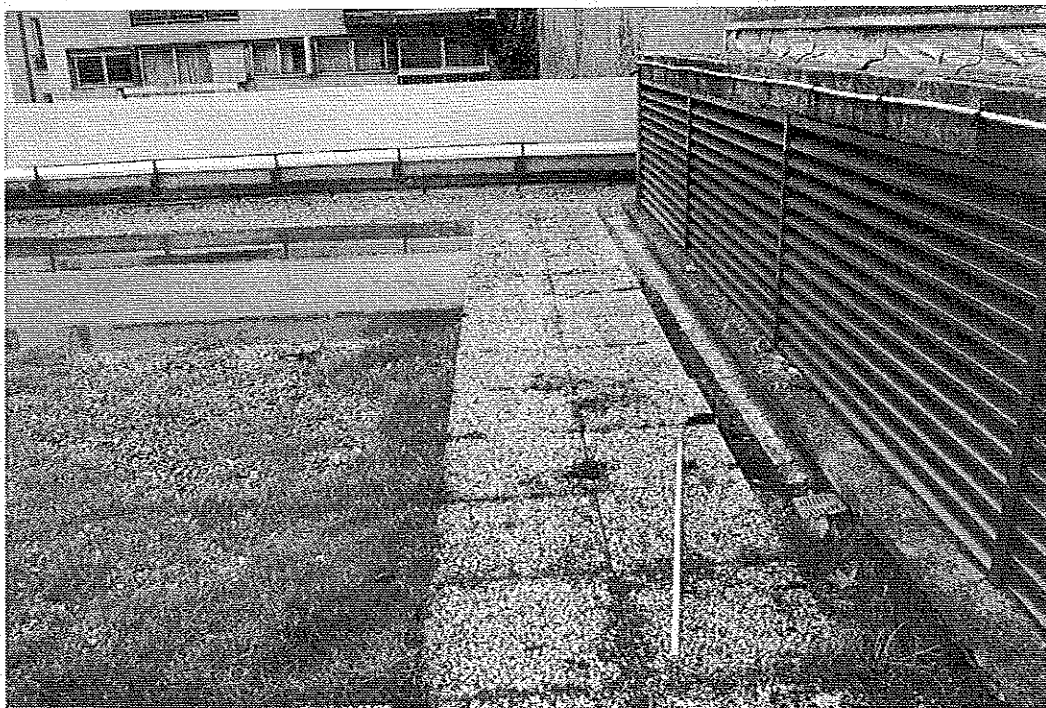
Zone opposée (sortie ventilation parking). Dispositif d'évacuation EP bloqué en limite.
